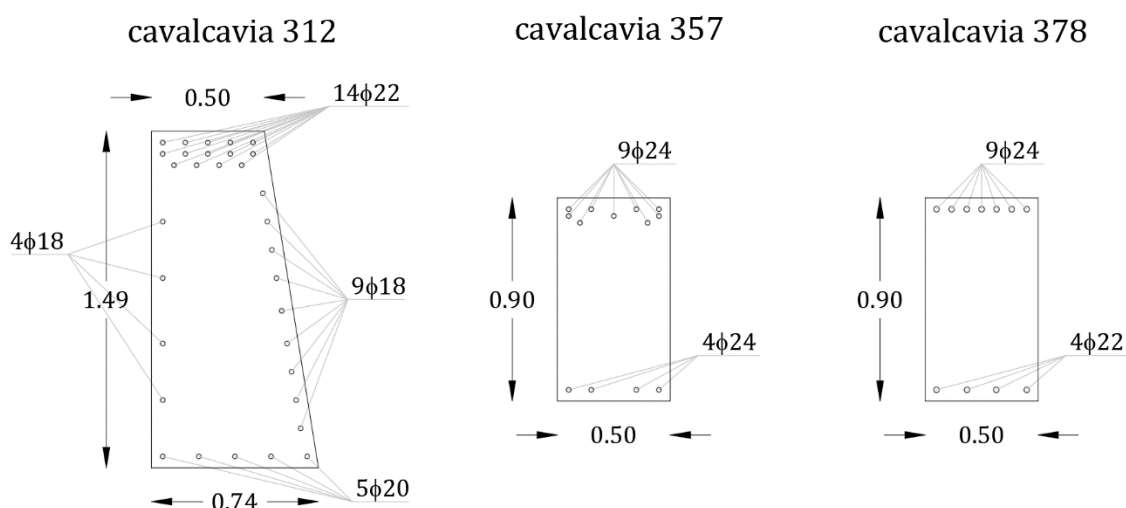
Sezione dell'architrave delle spalle e disposizione dell'armatura (piano x-z)
